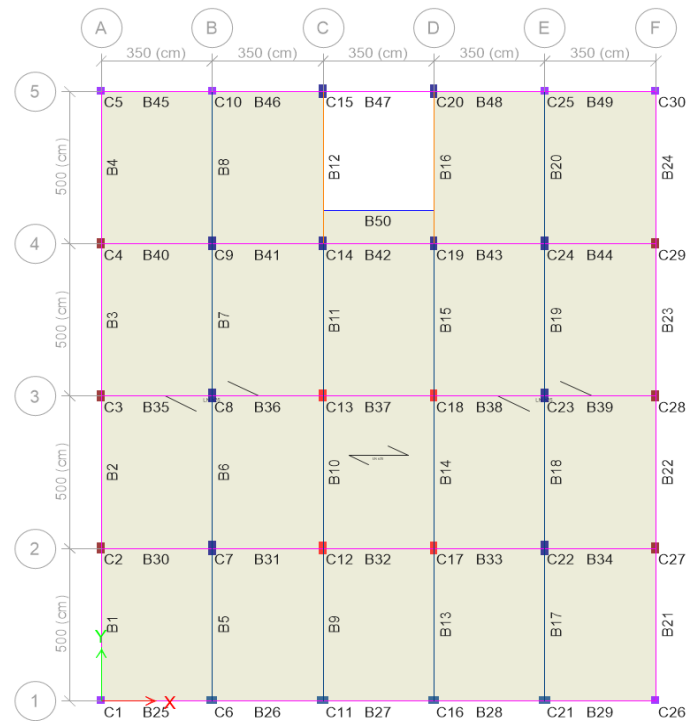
Planta Nivel 2, Elev. +5.78 m Caso 5 y 6.
